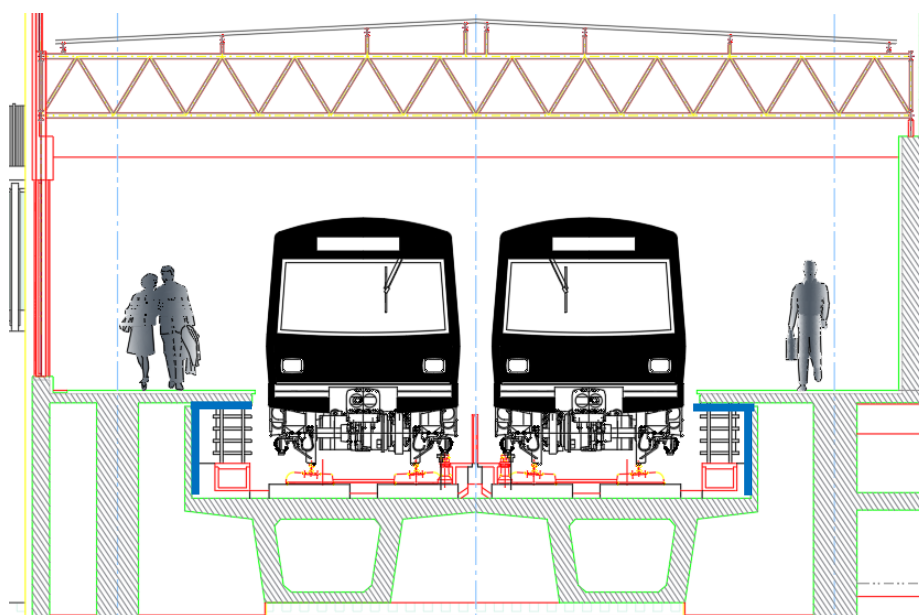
Aplicação de material absorvente sonoro (a azul) – Corte
